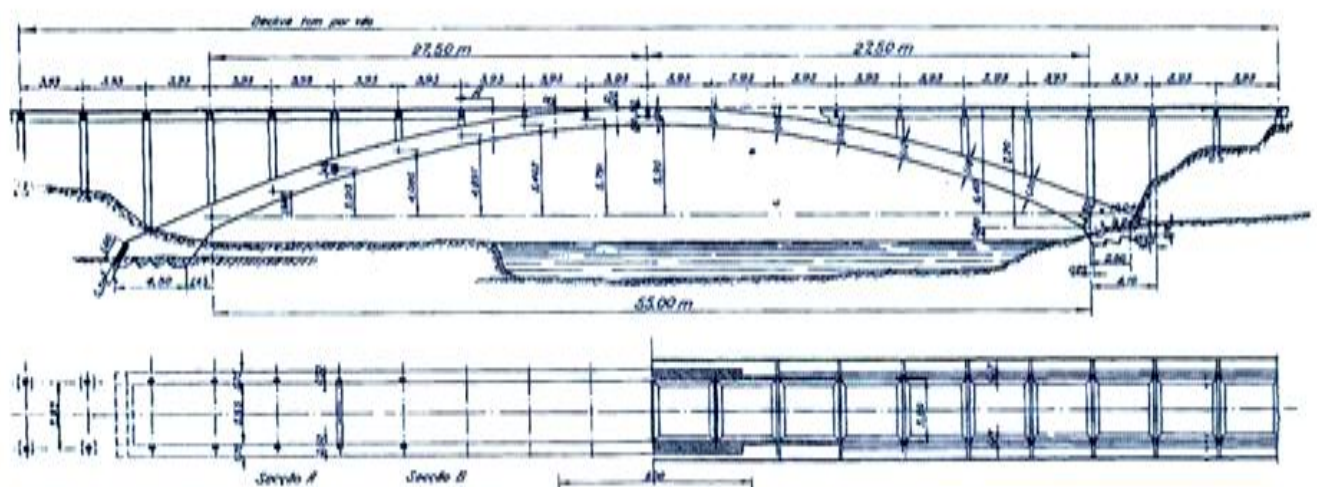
Elevação da ponte Victor Konder e planta do tabuleiro vista por baixo.
